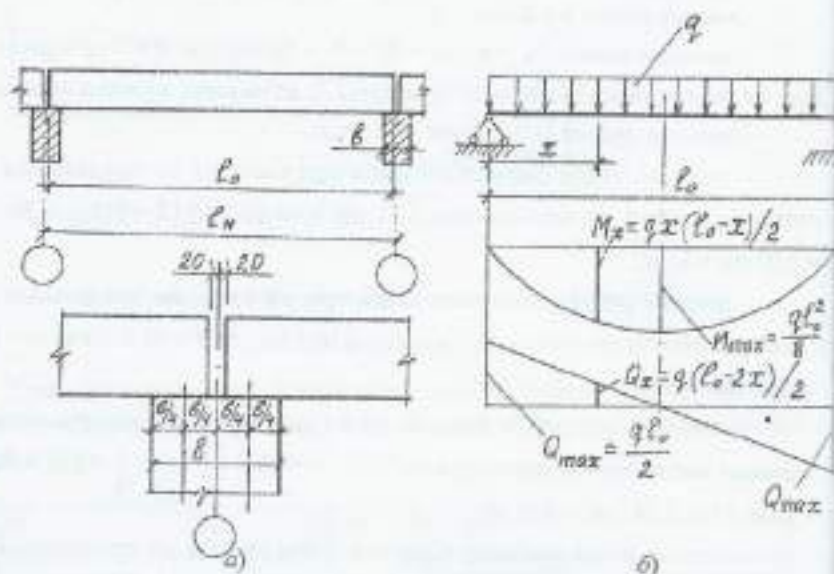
Расчетная схема многорукавной плиты: а – конструктивная схема, б – расчетная схема
